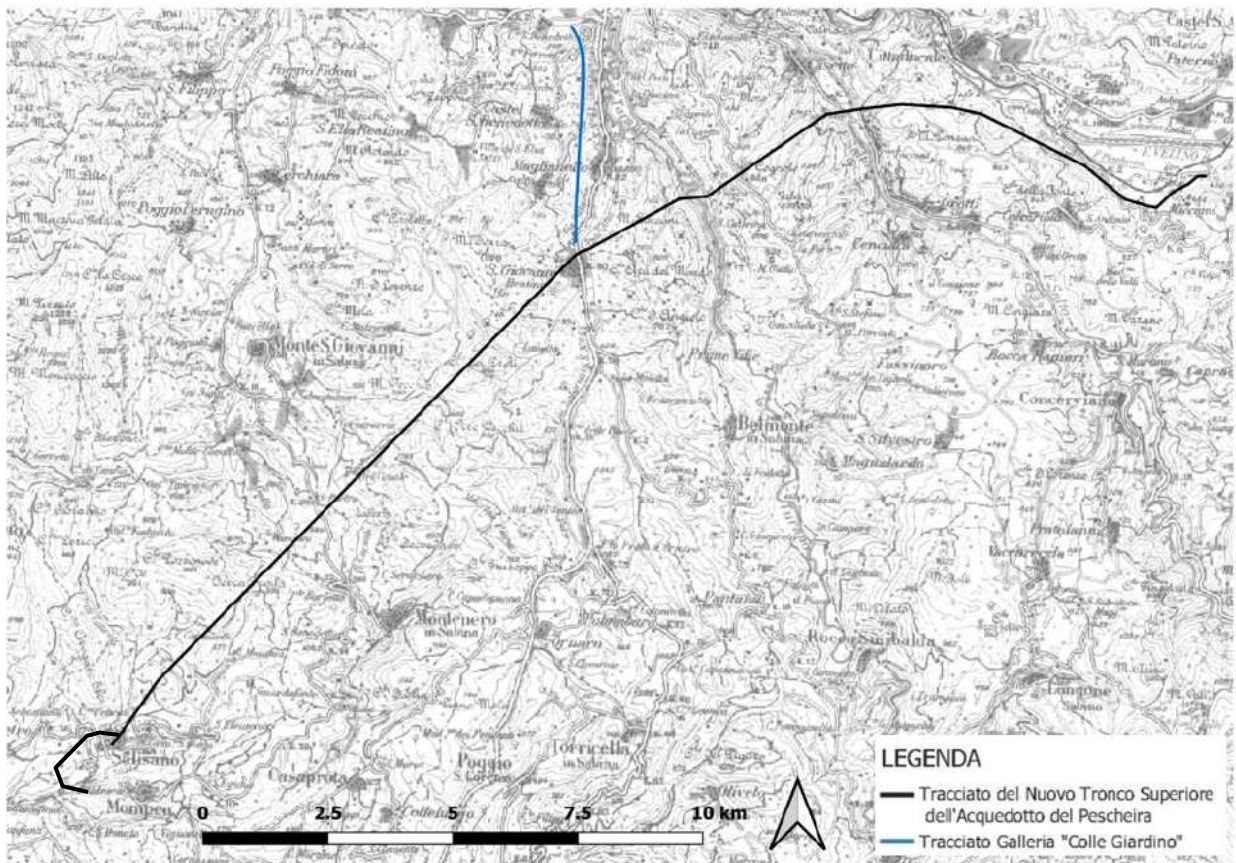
Posizione planimetrica della galleria ANAS di Colle Giardino rispetto all'asse della galleria di progetto.
